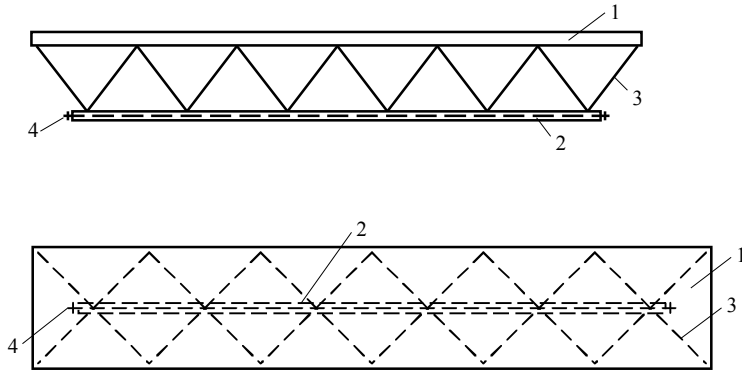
Попередньо напружена стале залізобетонна лінійна структурна плита: 1 – залізобетонна плита; 2 – нижній пояс із сталеві труби; 3 – розкоси; 4 – попередньо напружена арматура.
